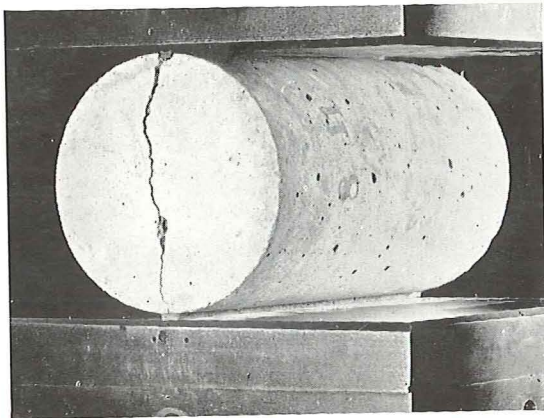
Spaltningsforsøg til bestemmelse af en betons trækstyrke.
